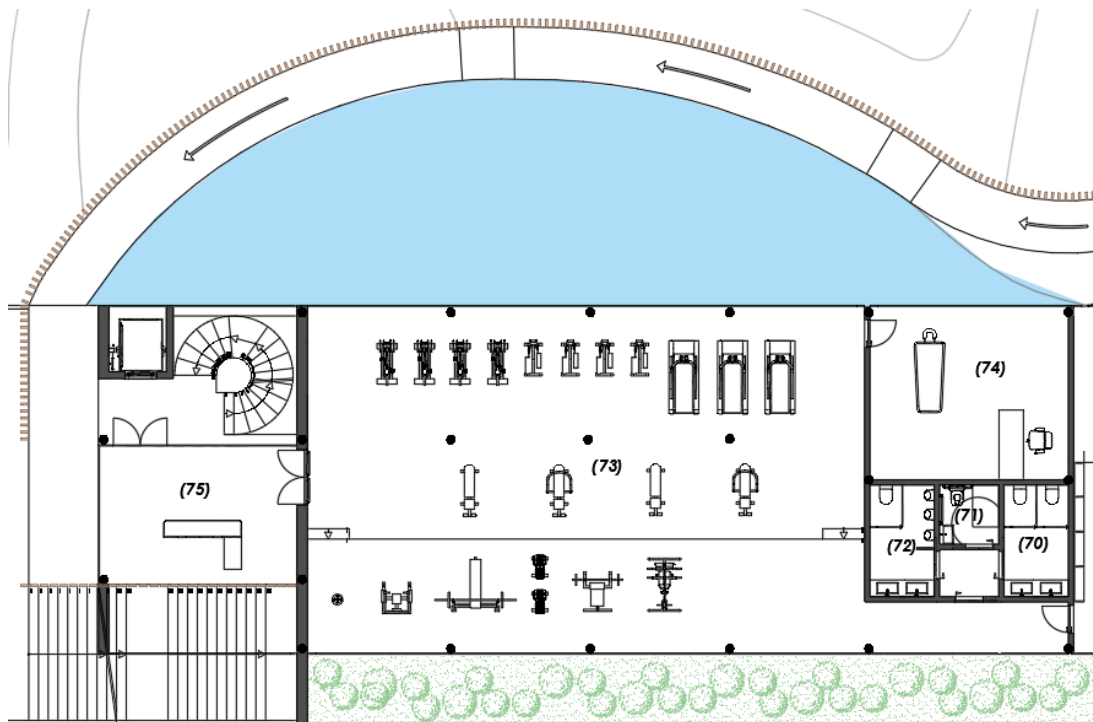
PLANTA E CORTE DO GINÁSIO (PISO 1)
